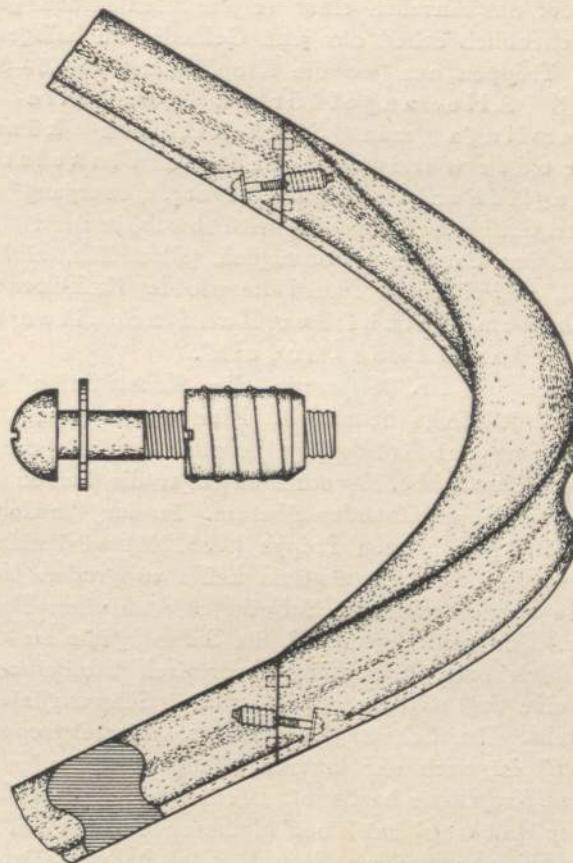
Die „Rampa- oder Hamburgerschraube“.
